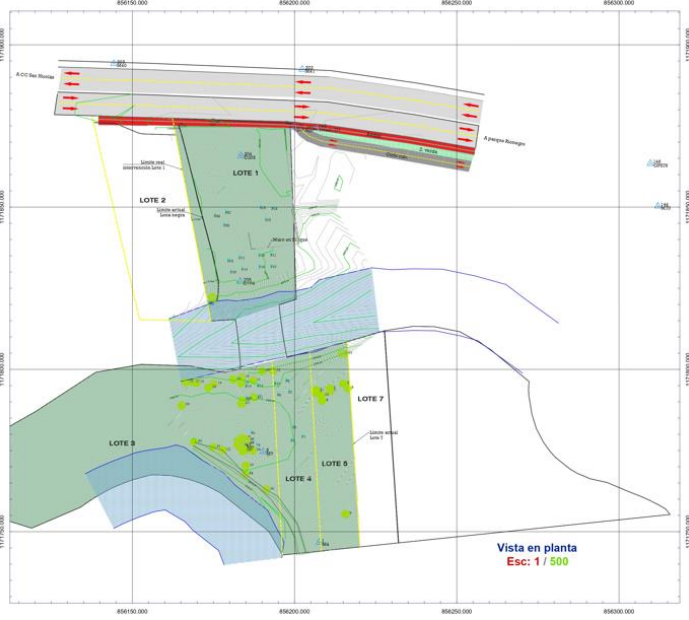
Plano del proyecto. *Tomado de la solicitud.
